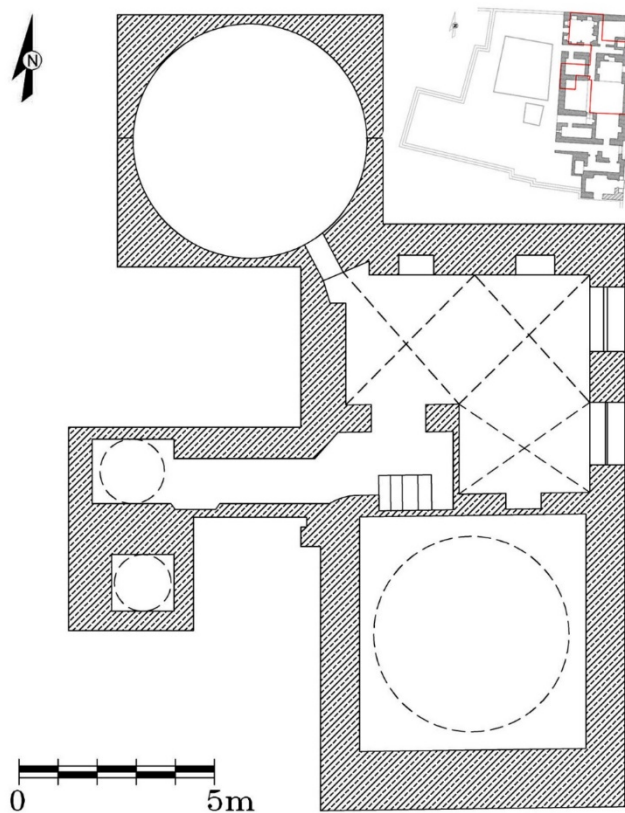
La demeure Mūfid al-'Āmīn : plan du second étage. Ğ. TAQTAQ, 'I. AL-MASRI
